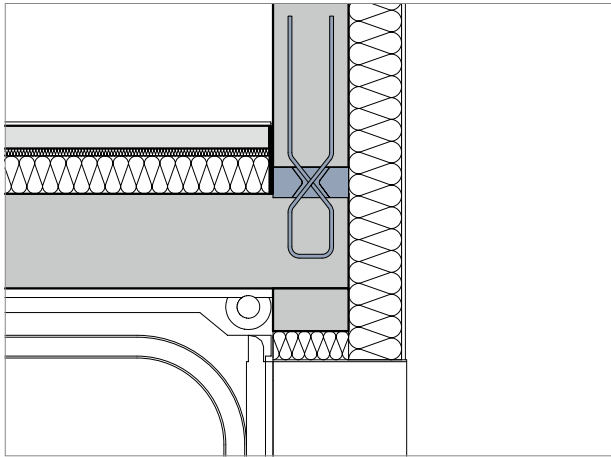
Sconnex® Typ W bei Aussenwand und Aufdeckendämmung über Tiefgarageneinfahrt
